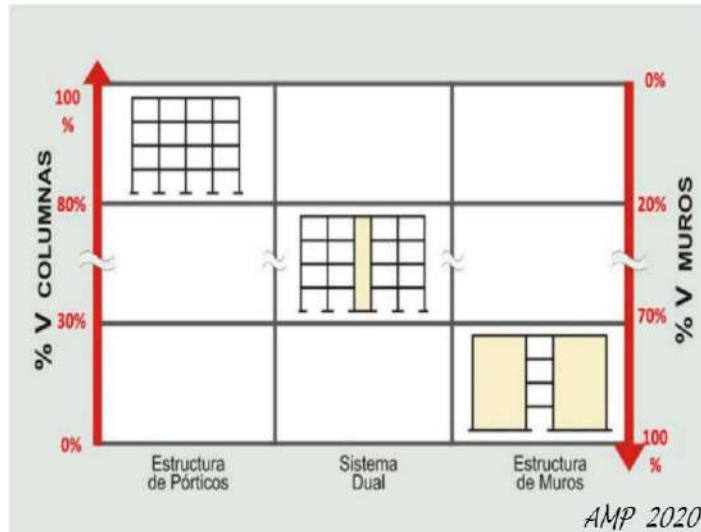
Clasificación de los sistemas estructurales en concreto armado
